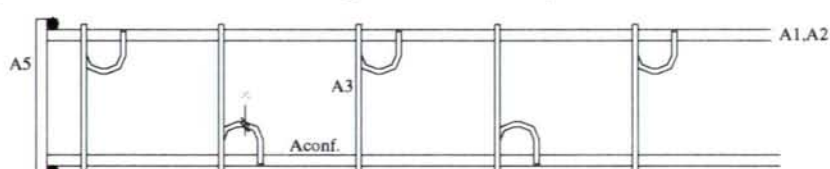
Disposición en planta de la armadura de las vigas
